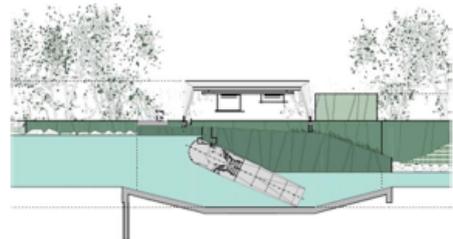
Das Kraftwerk Salzach mit den entsprechenden Kenndaten (Quelle: Flussbauliches Sanierungsprojekt Freilassingener Becken mit standortoptimierter energetischer Nutzung, S.12)
